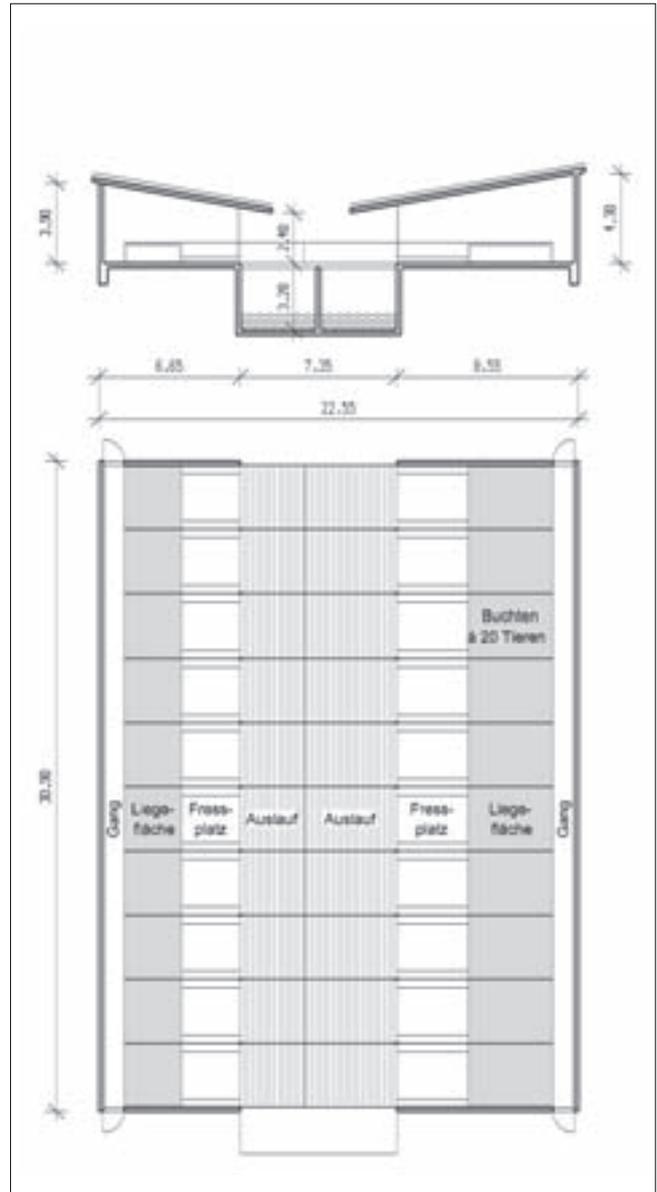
Label-Maststall für 400 Mastschweine. Offenstall mit Vor- und Ausmast, Buchten für 20 Tiere mit Liegekisten. Auslauf auf Güllengrube.
